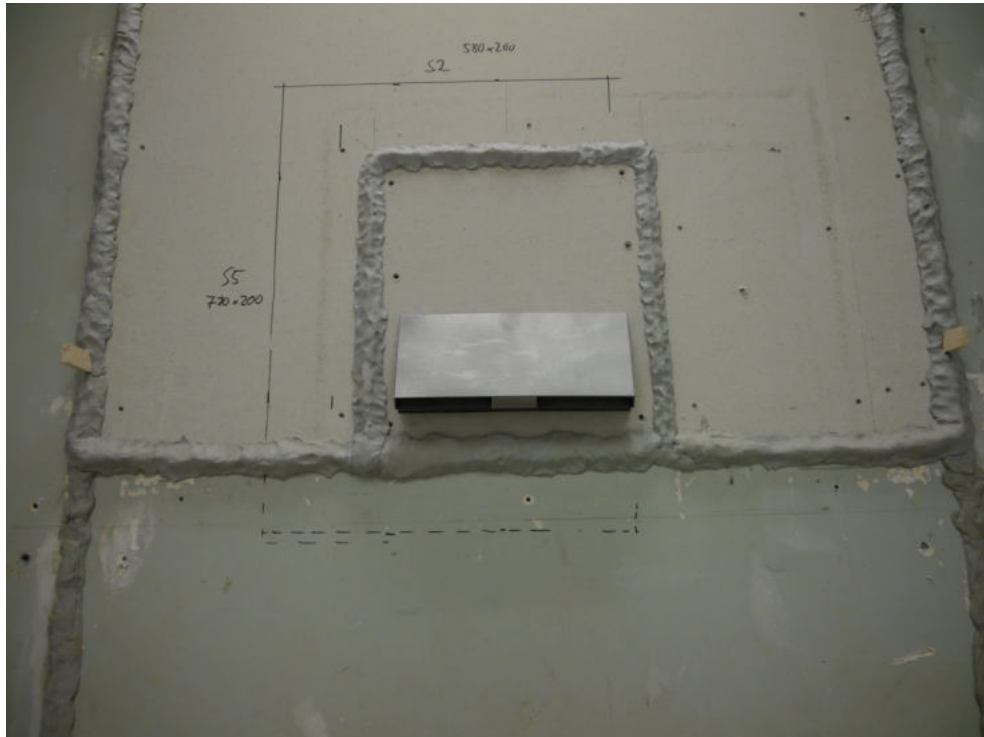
Lüftungsöffnungen außenseitig mit fertig montiertem Fassadenabschluss Edeltstahlschote (Ansicht Senderraum prüffertig).
